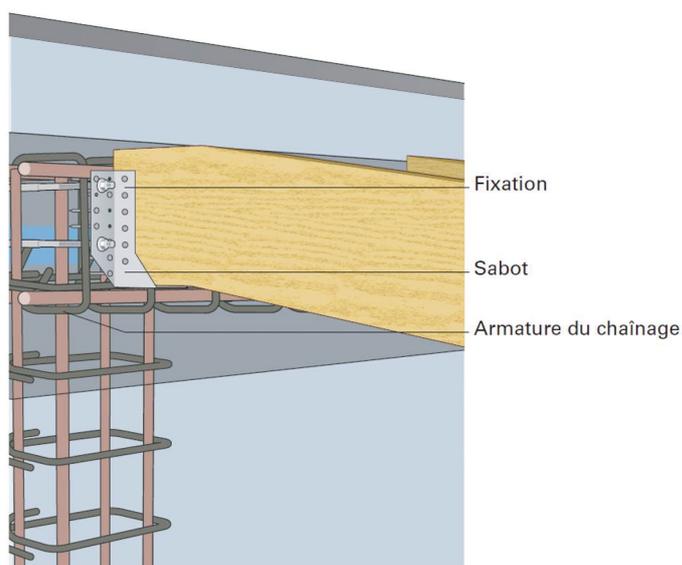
Exemple structure/charpente d'un auvent et structure/charpente du bâtiment (3)
